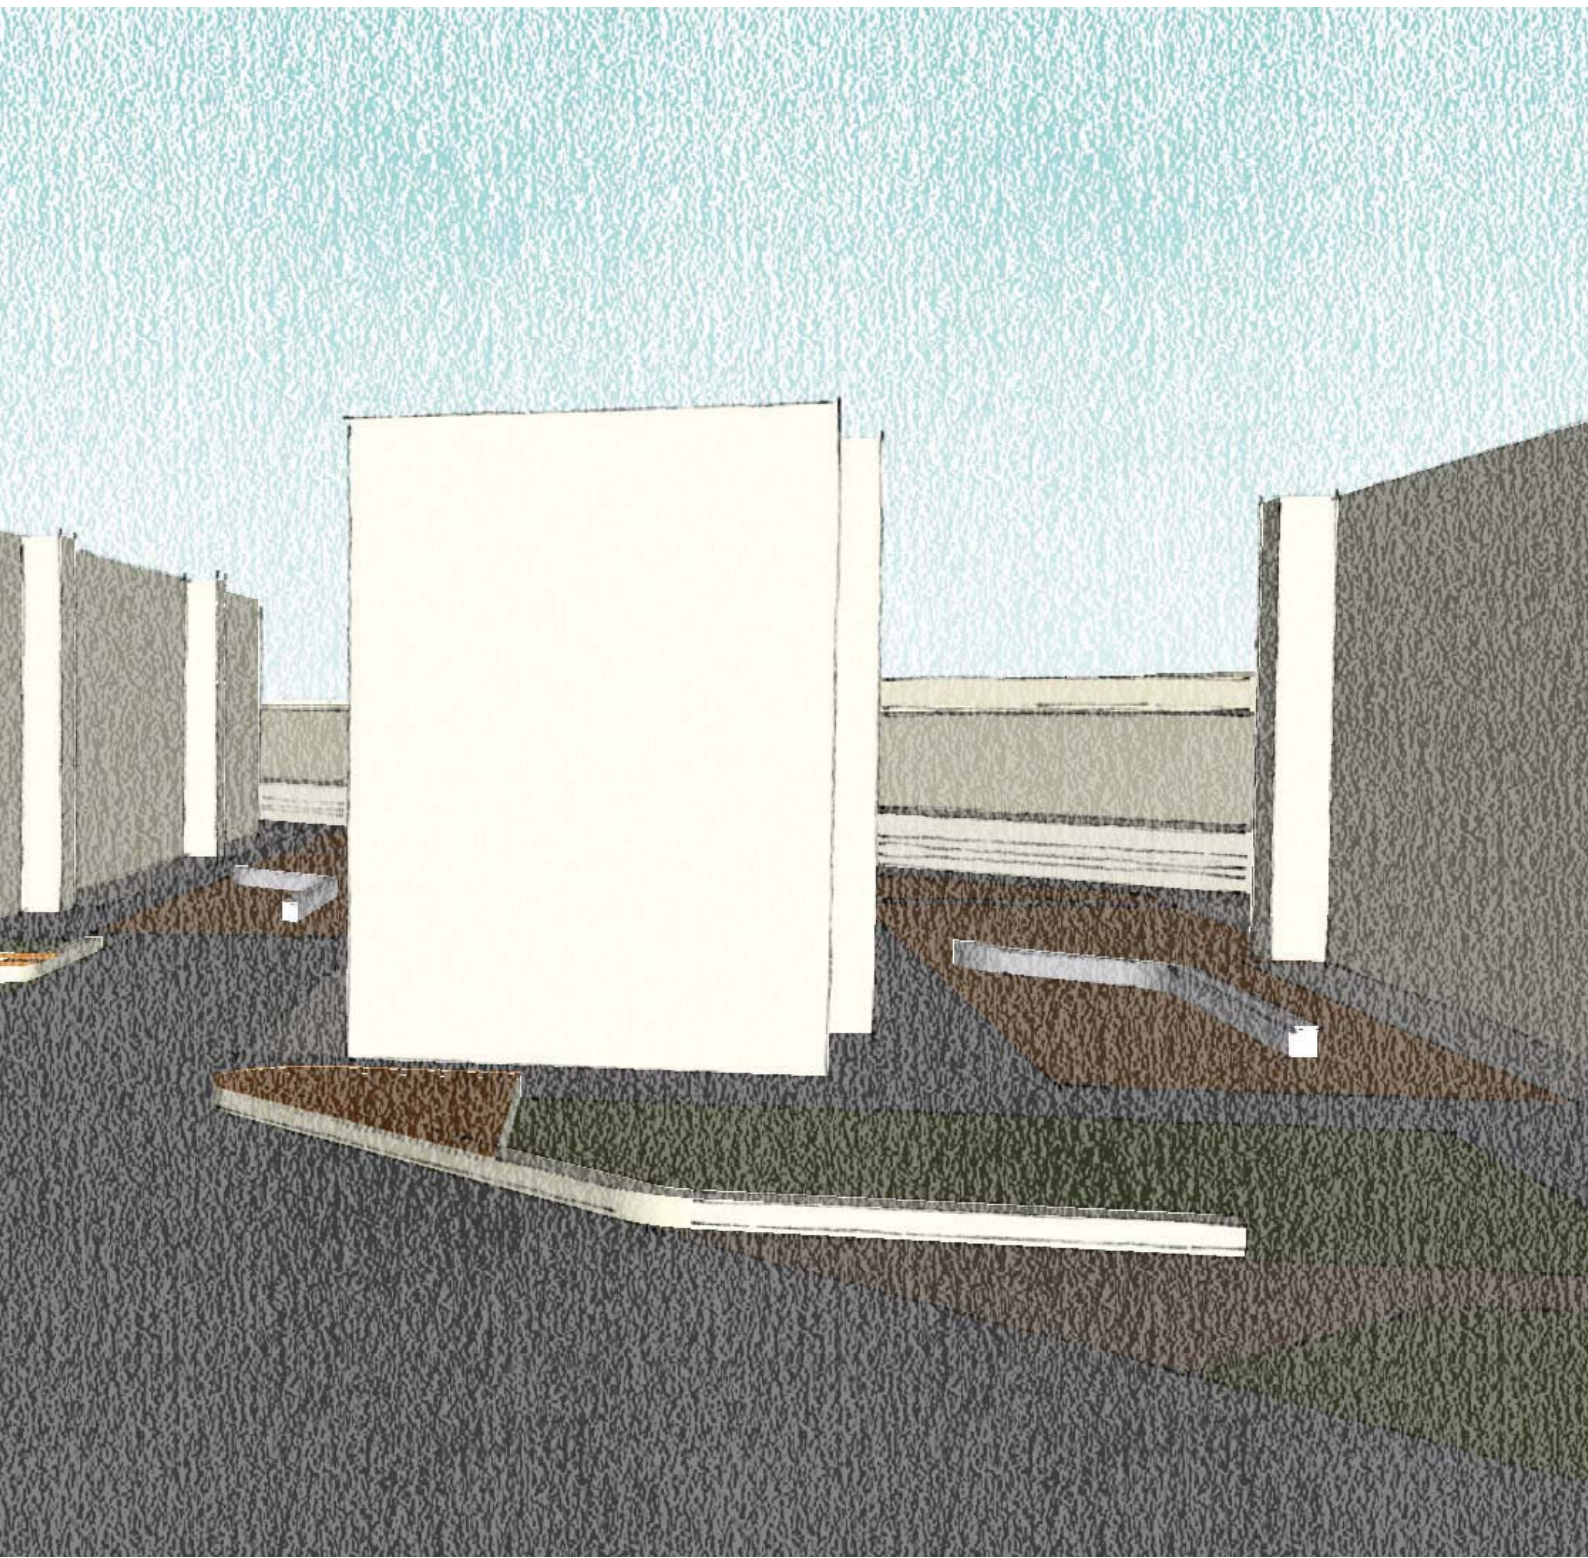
Render | Propuesta arquitectónica Multifamiliar Tlalpan
